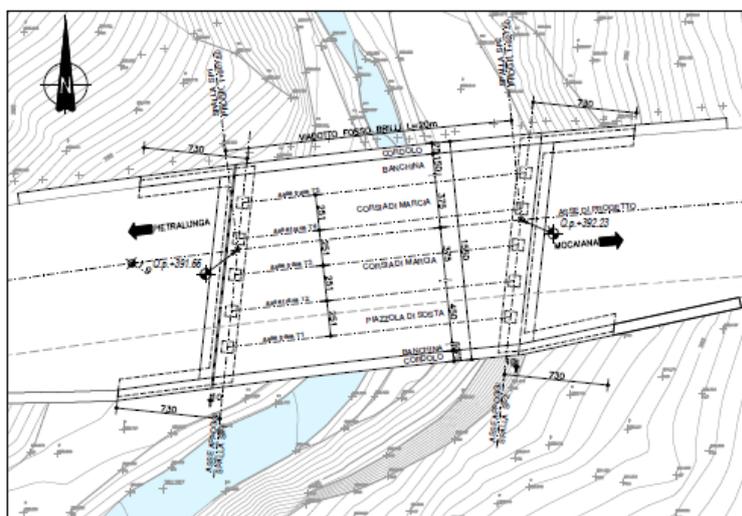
PLANIMETRIA VIADOTTO FOSSO BRILLI
